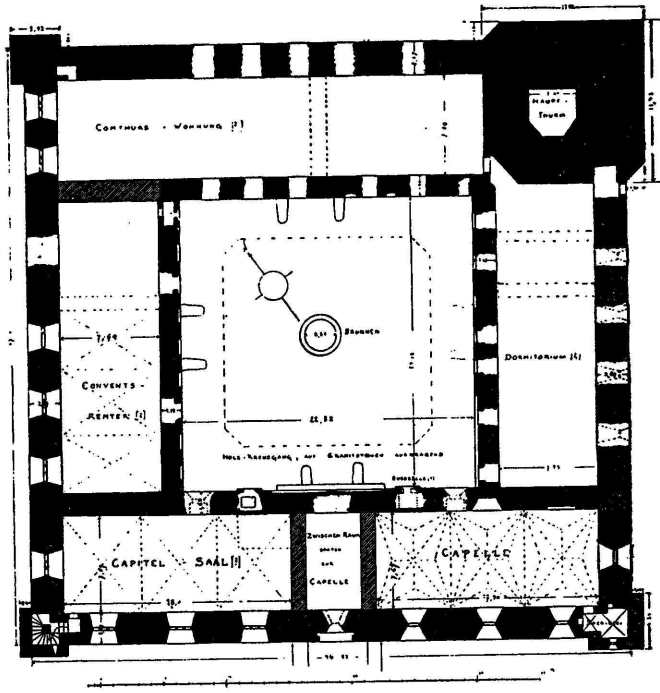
Mewe, Grundriss des Hauptgeschosses. Nach Steinbrecht.
